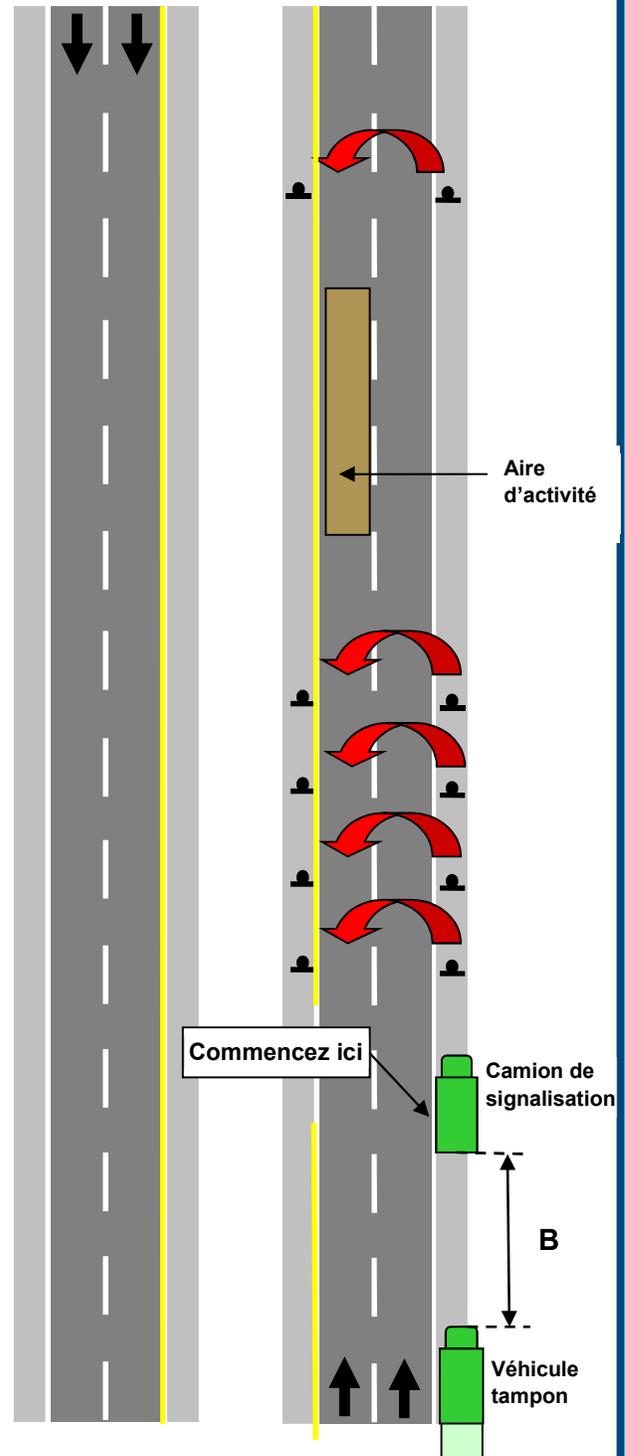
Installation des panneaux (routes à voies multiples à chaussées séparées)
